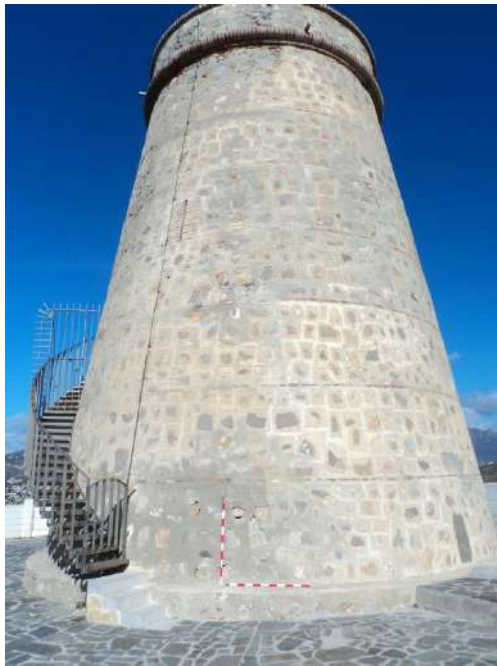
mampostería con verdugadas de ladrillo en torre punta de la Mona
